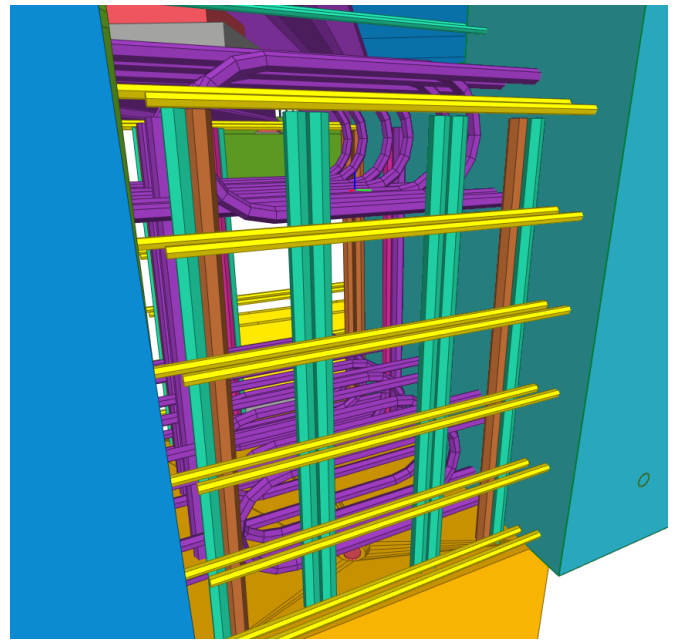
Vista del modelo en el encuentro de los pilares prefabricados con los dinteles prefabricados.
